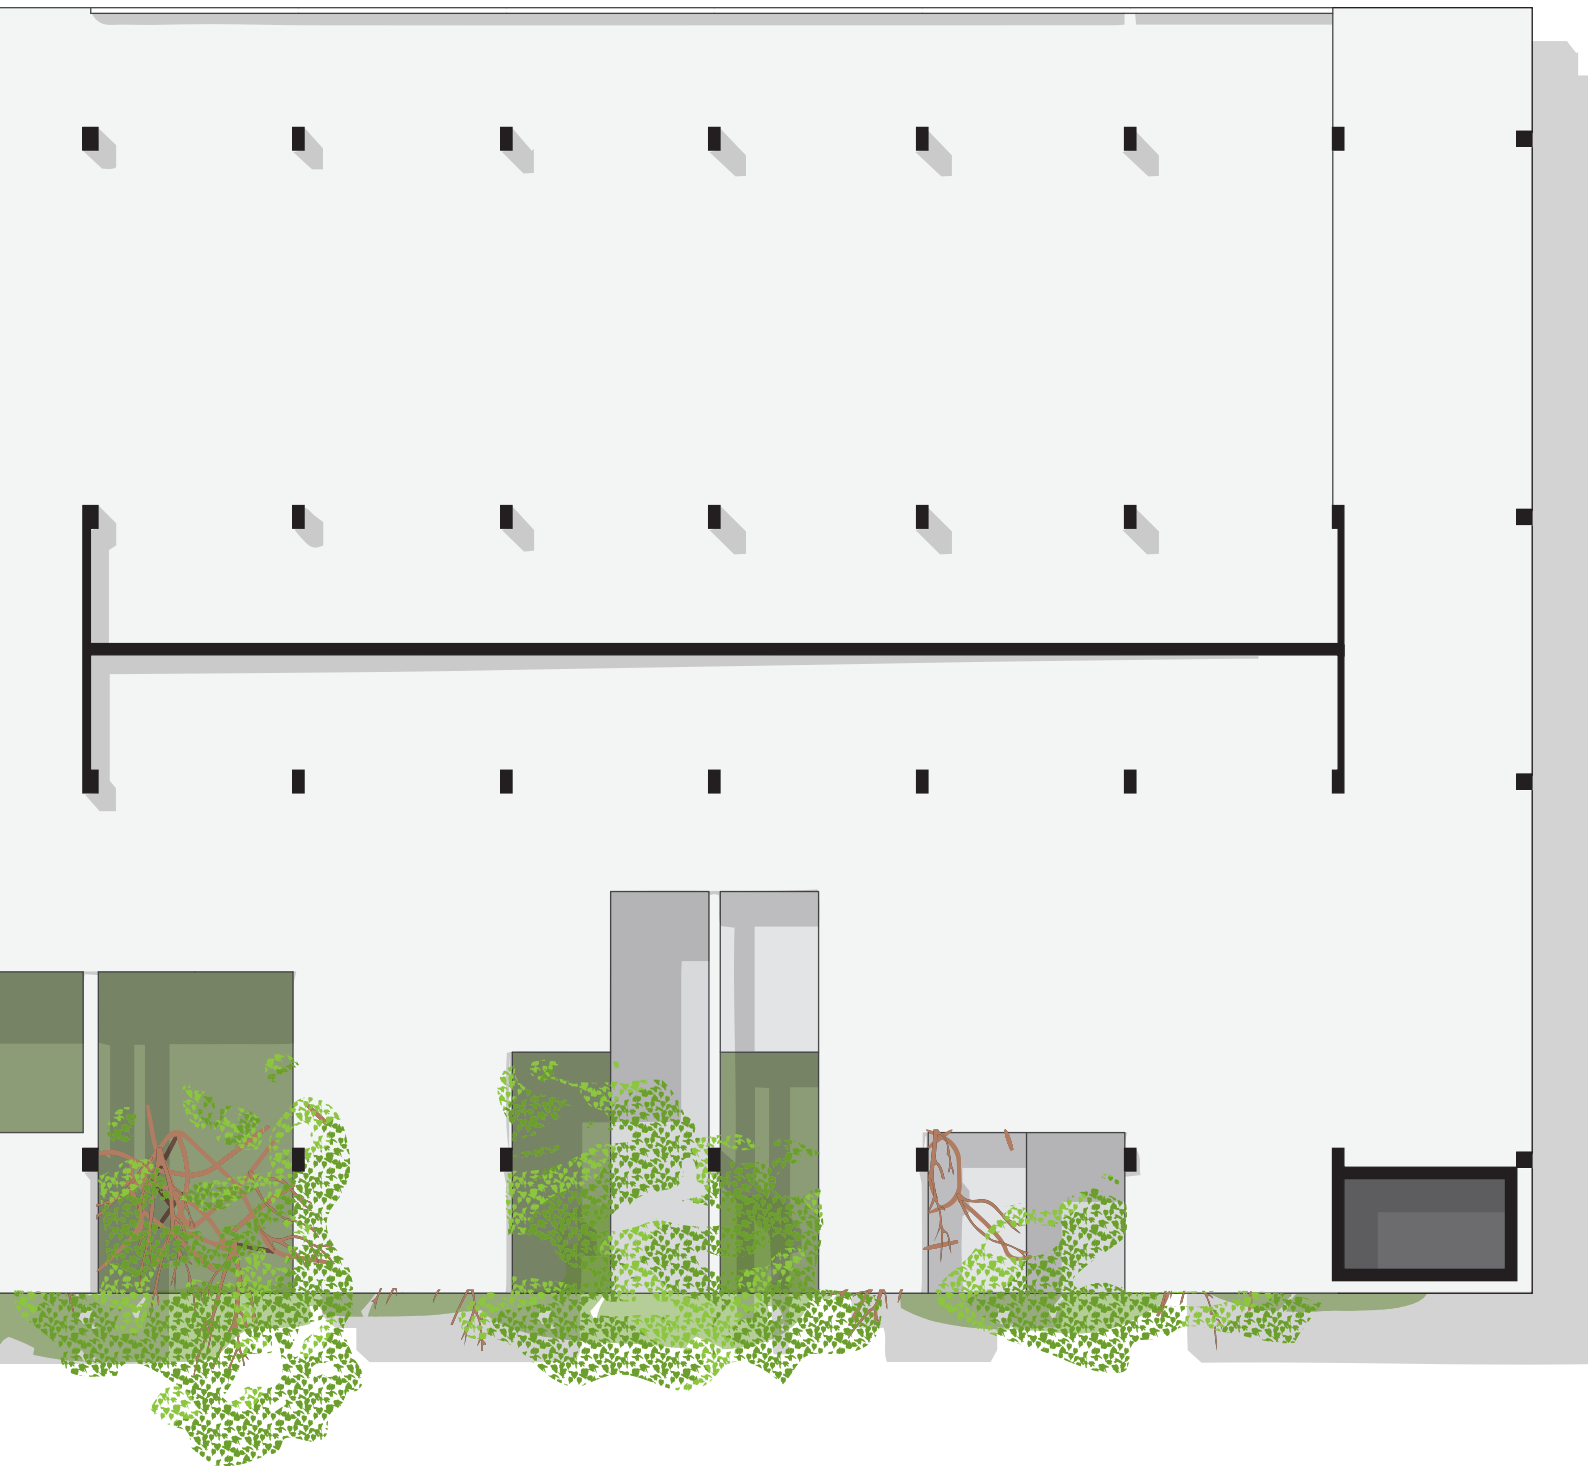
Grundriss OG. M 1:200
